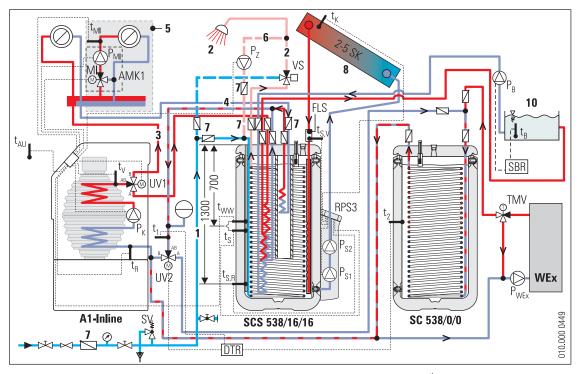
Integrazione di una caldaia a legna mediante bollitore tampone e integrazione di una piscina<sup>1)</sup> nell'SCS 538/16/16
